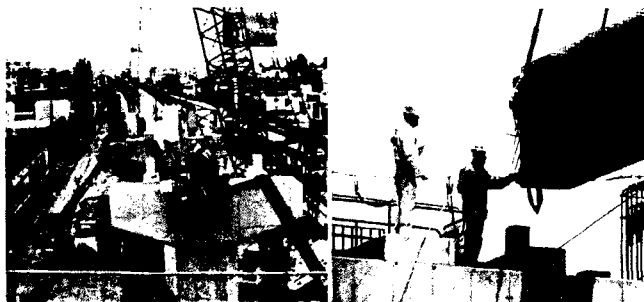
Posicionamiento de la viga en vigas cabezales .
